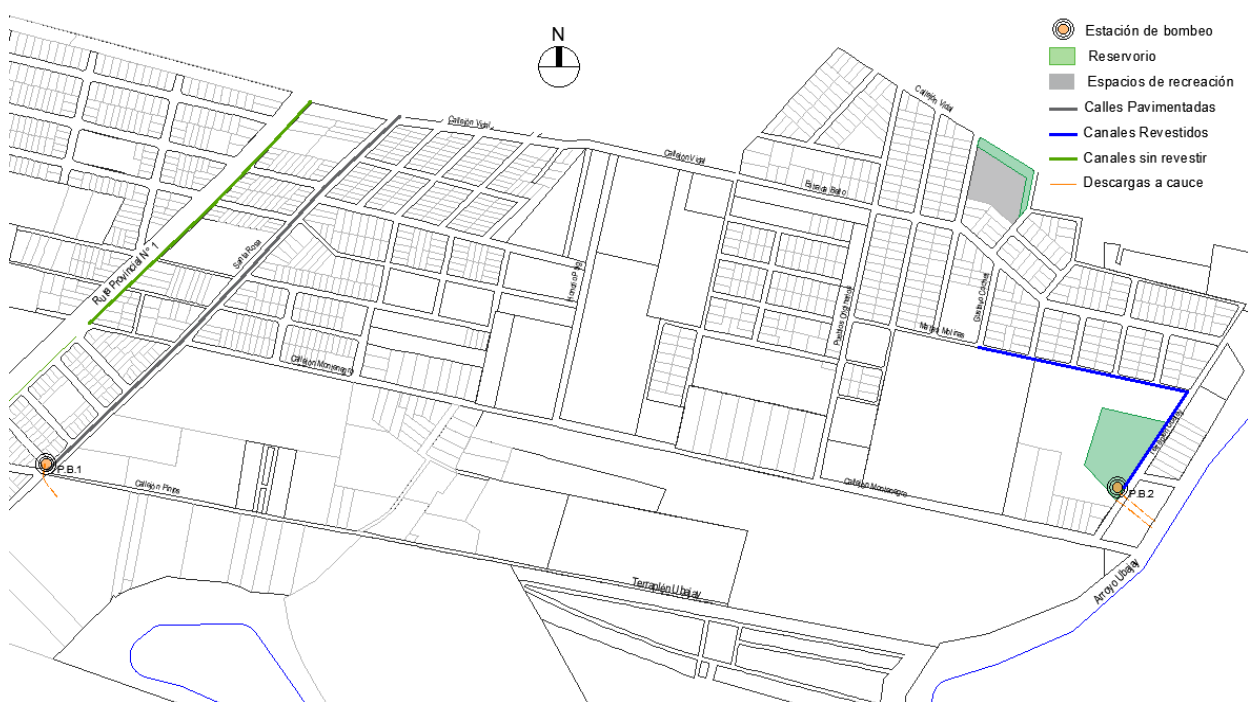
Alternativa de proyecto n°1. Fuente: Elaboración propia.
